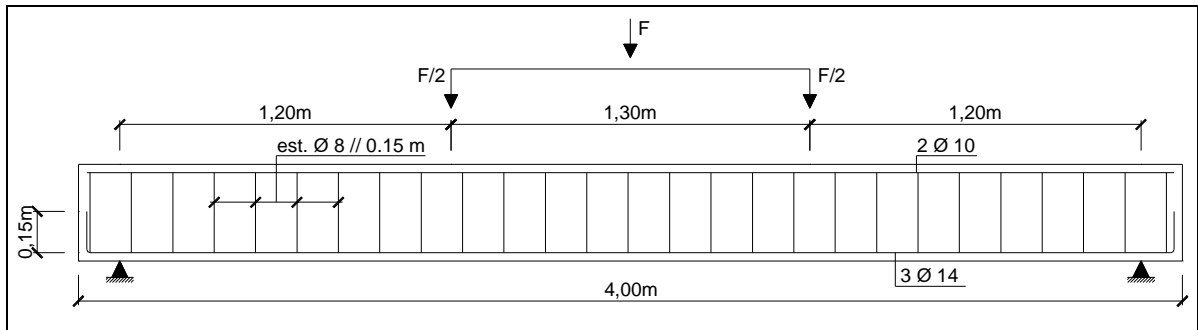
Secção longitudinal das vigas de aço inoxidável do tipo HSS3 da 2.ª série.
